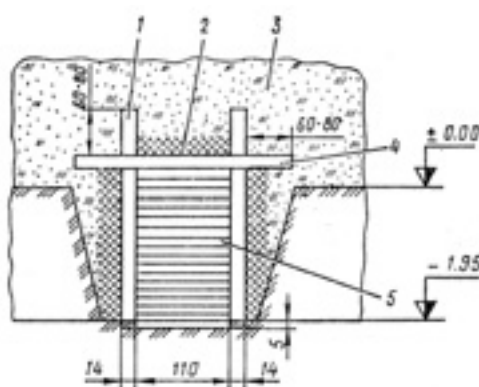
Быстровозводимое убежище на 10 чел. из железобетонных перемычек: 1 – перемычка 1 ПРЗ-24.12.14; 2 – утрамбованный грунт; 3 – насыпной грунт; 4 – перемычка 1 ПРЗ-22.12.14; 5 – перемычка 1 ПР2-15.12.6
